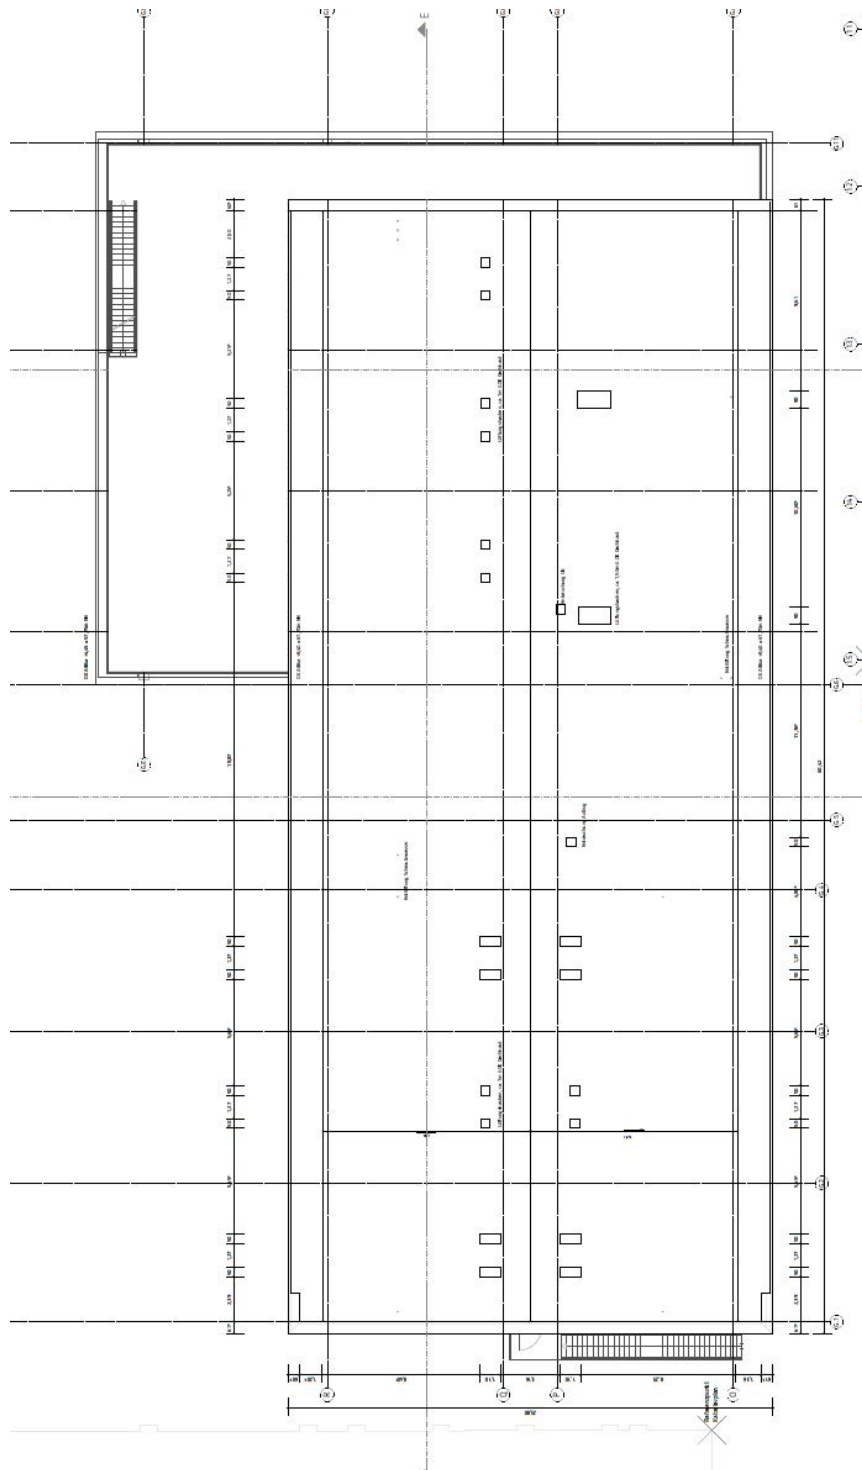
Grundriss Dach Neubau einer 2-zügigen Grundschule mit Mensa
